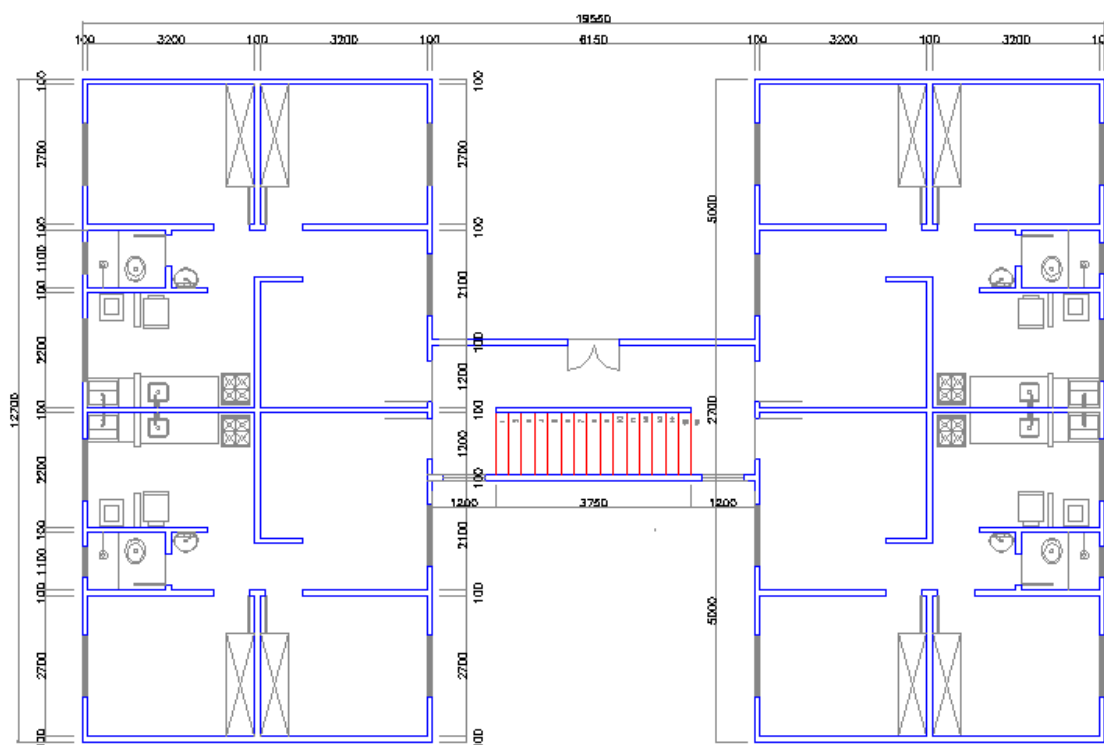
Planta Baixa do pavimento tipo do modelo tipo “A” para os sistemas aporticado e LSF
